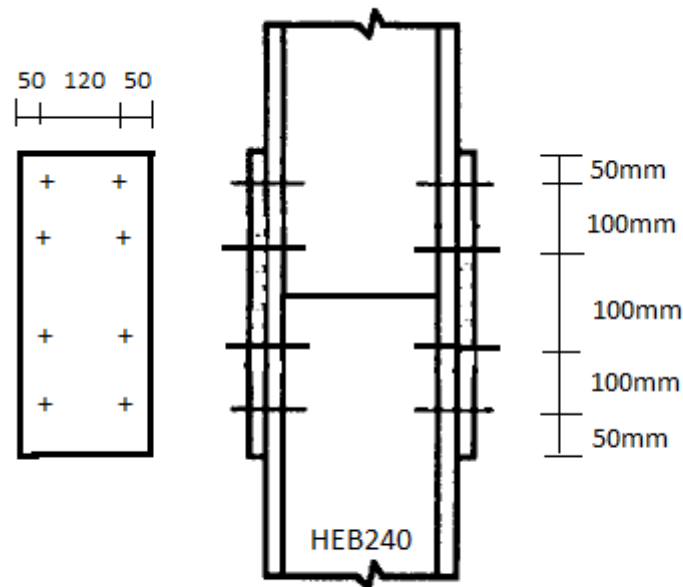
Assemblage poteau-poteau (couvre-joint de la semelle)
